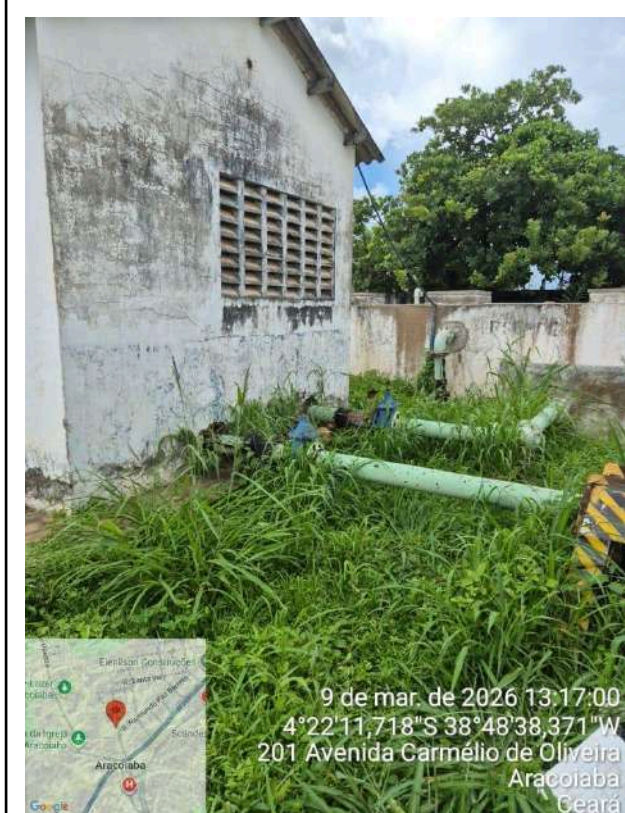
EEAT-03: parede externa desgastada, vegetação elevada.
